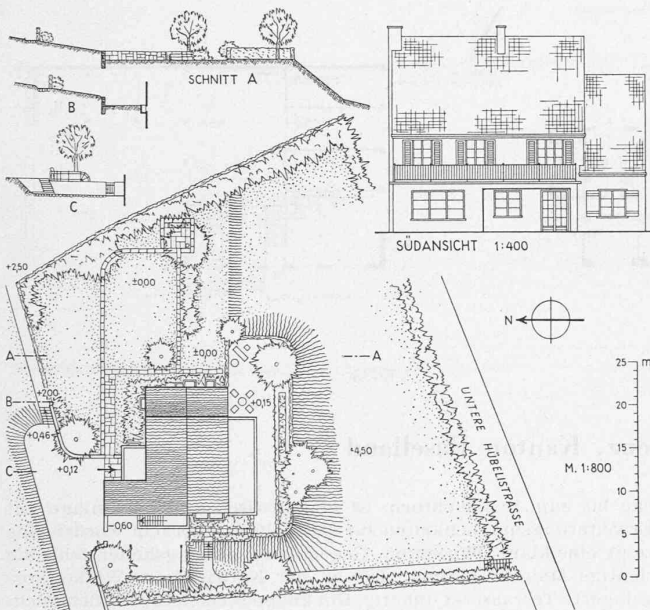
Landhaus Dardel in Zofingen. — Lageplan 1:800
